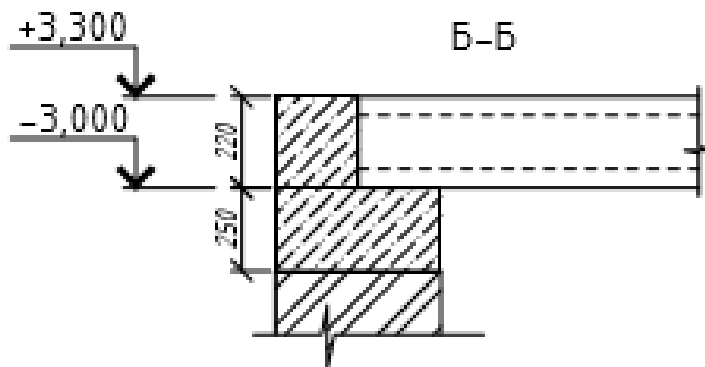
Узел опирания плиты перекрытия на железобетонный сейсмопояс
